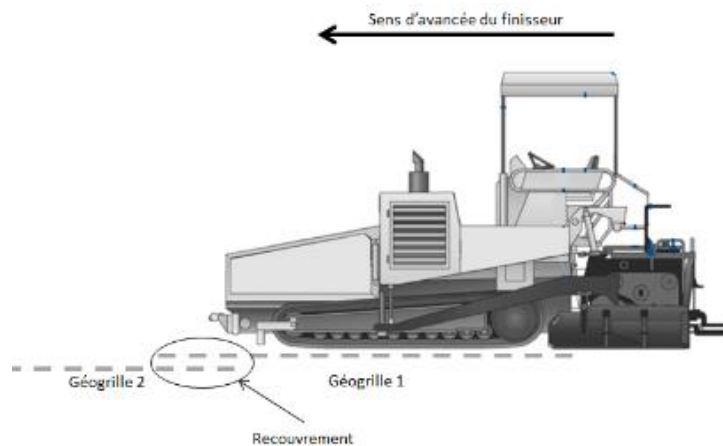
SENS DE RECOUVREMENT BOUT-A-BOUT
